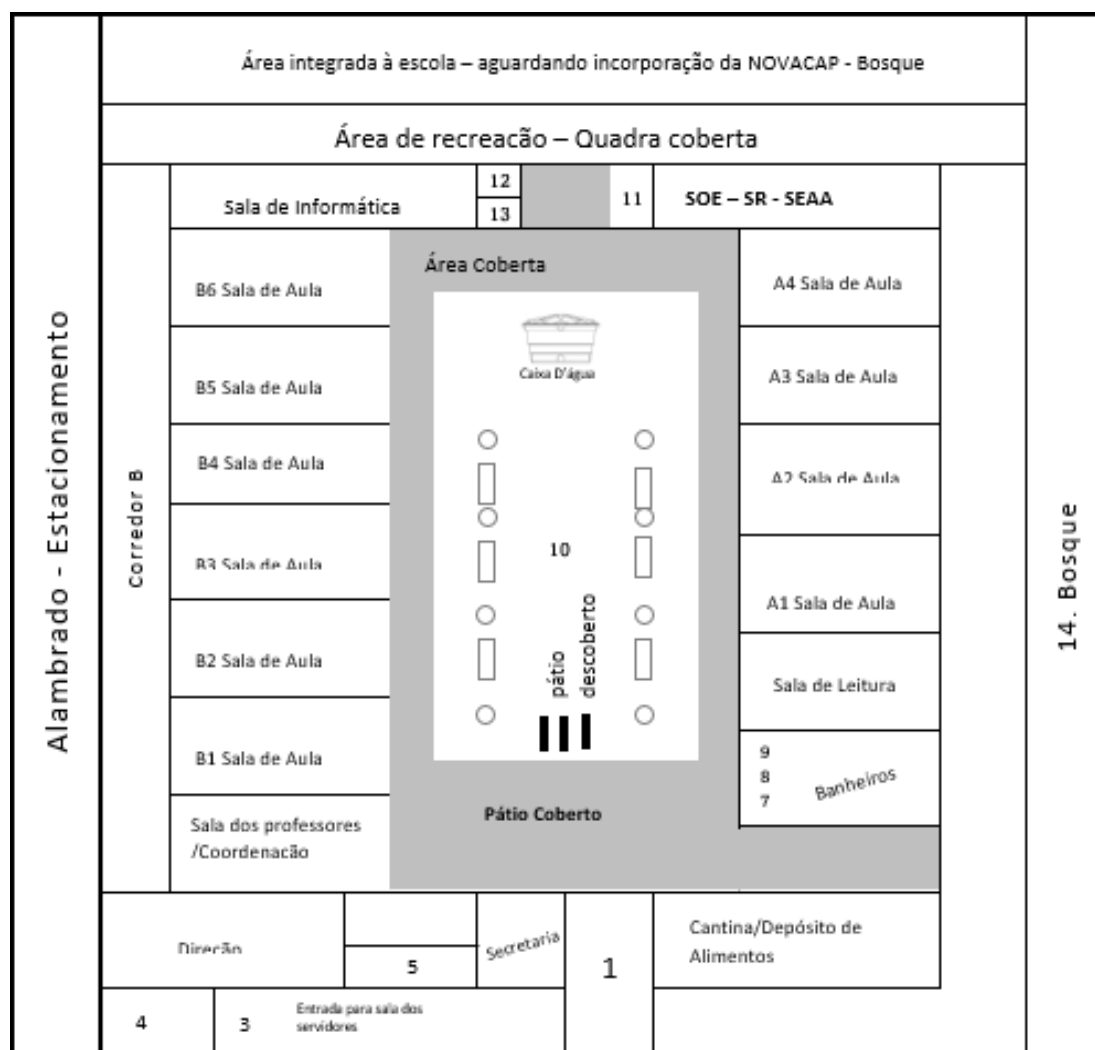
PLANTA BAIXA DA ESCOLA CLASSE 12 EM 2022
